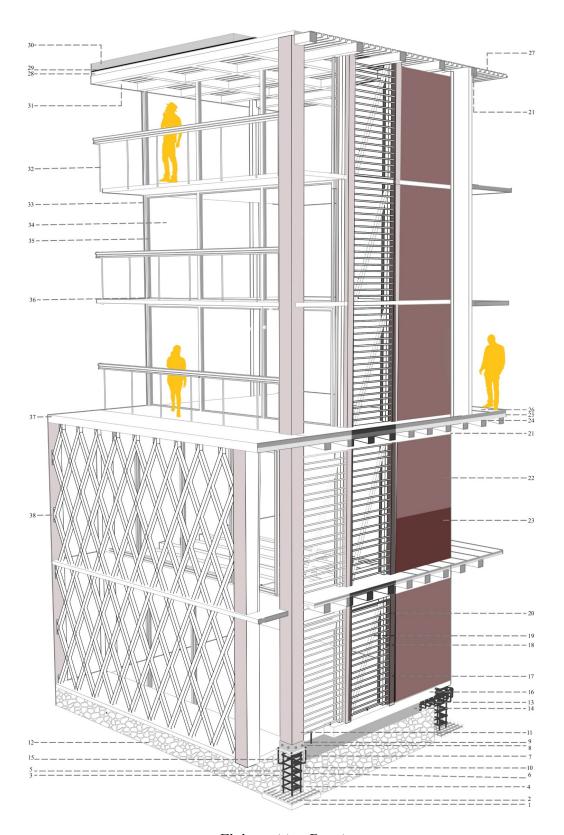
Sección constructiva del modelo arquitectónico propuesto
